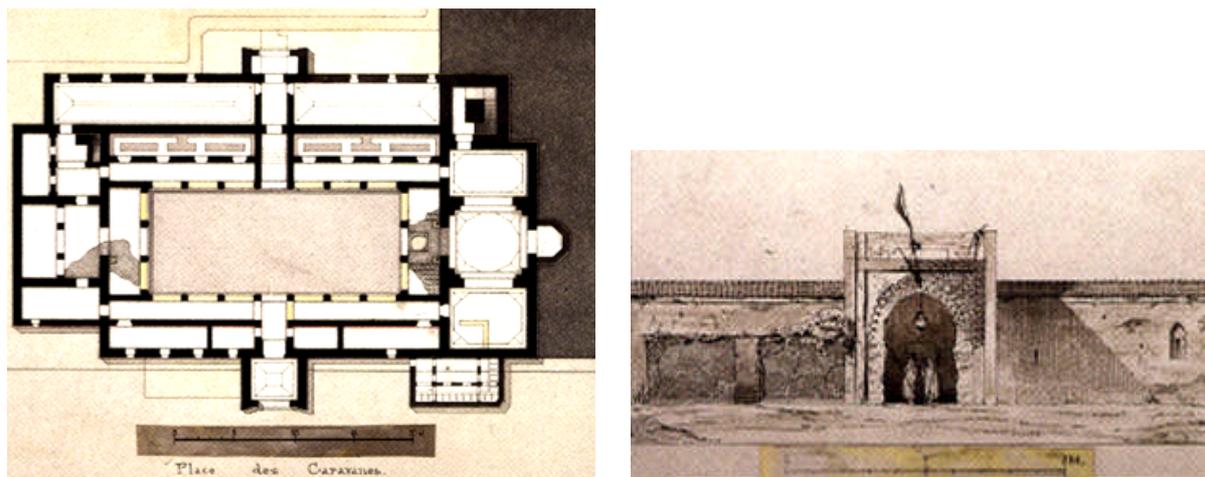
Plan et Façade de la Medersa Tachfinia par E.Danjoy, 1873 (Échelle 1/500,1/50).
